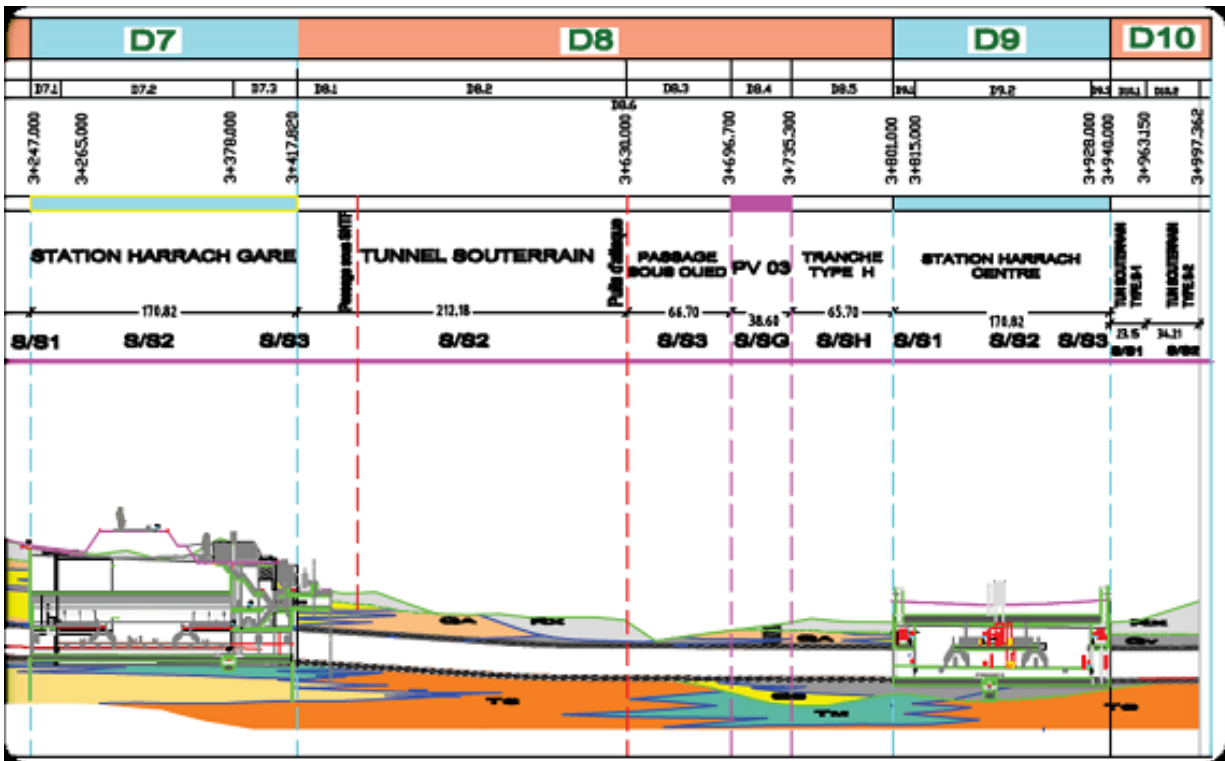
Implantation de l'ouvrage-coupe longitudinale. (Omrani K et Boutria H, 2012).
